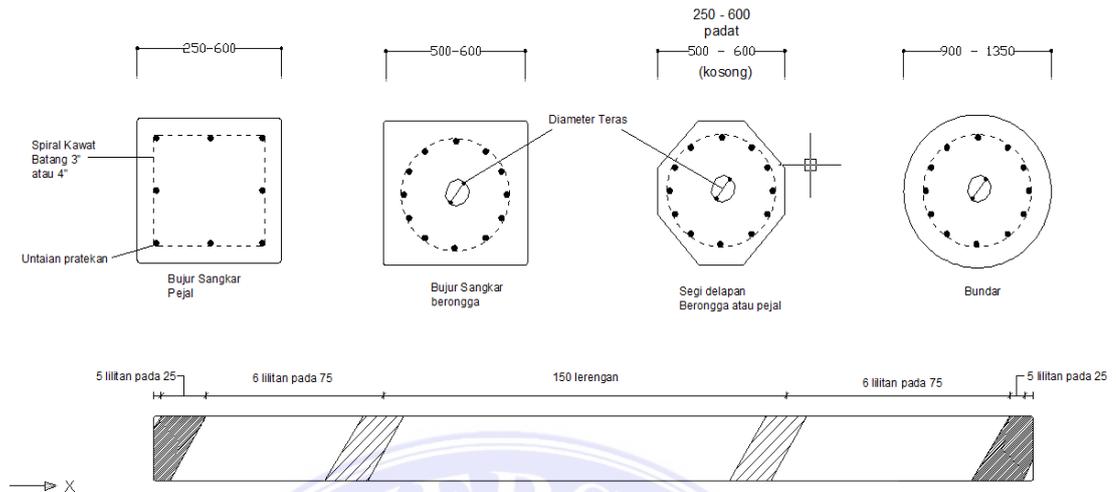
Tiang Pancang *Precast Reinforced Concrete Pile
